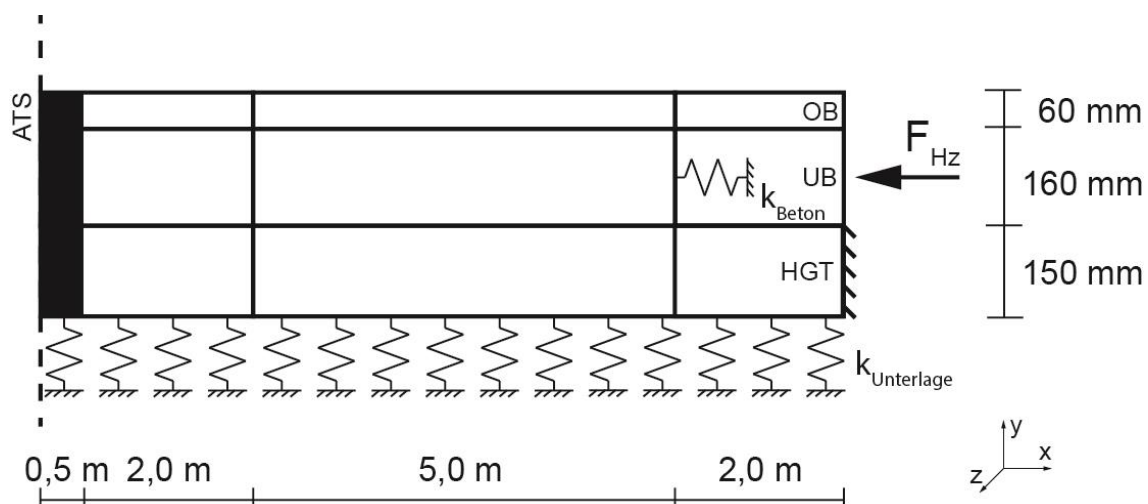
Finite-Elemente-Modell mit ATS-Streifen – Lagerung mit gelöstem Verbund zwischen Beton und HGT (halbseitige Darstellung)
